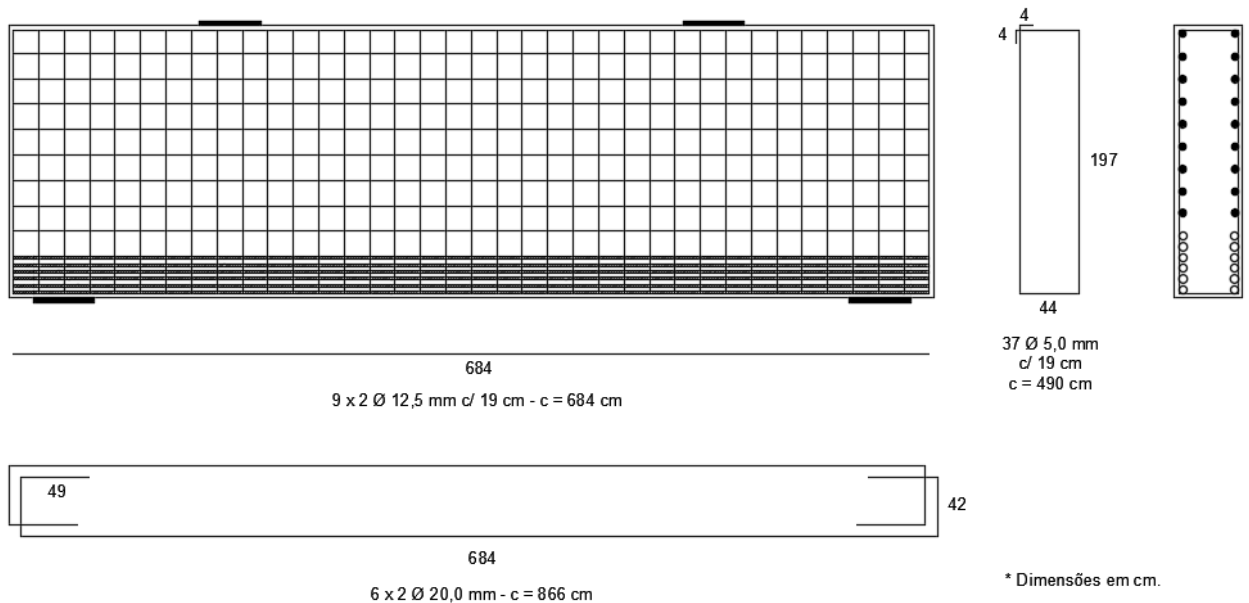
Detalhamento da armadura do modelo de viga-parede A, obtido com dimensionamento segundo Schlaich *et al.* (1987)
